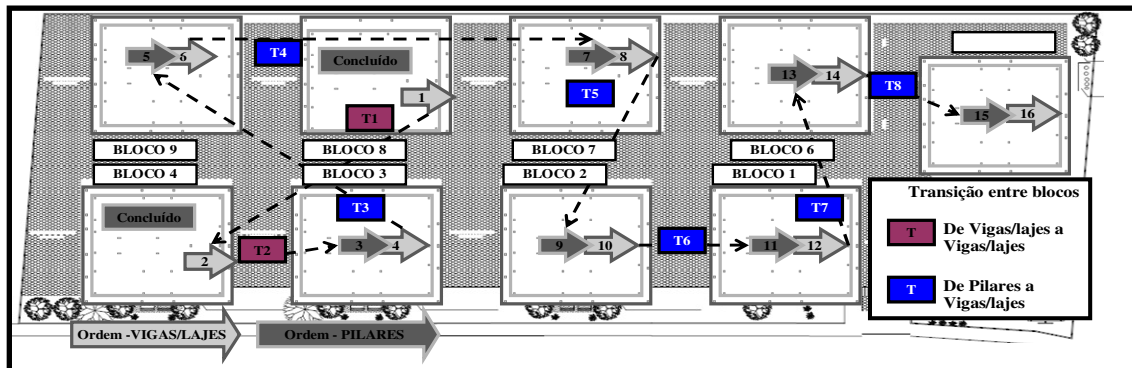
Novo plano de ataque para estrutura pilotis – Tático 2
